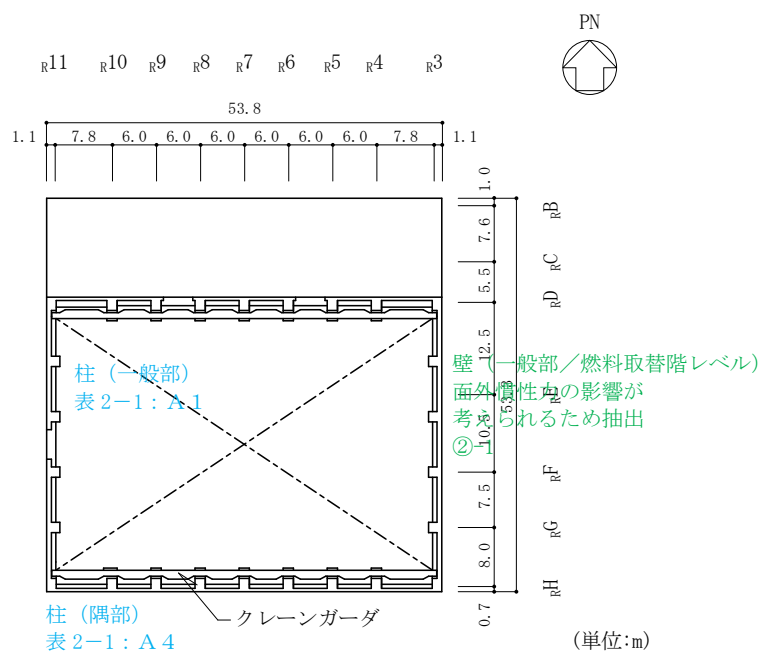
(8) 原子炉建物の概略平面図 (EL 51.7m)
